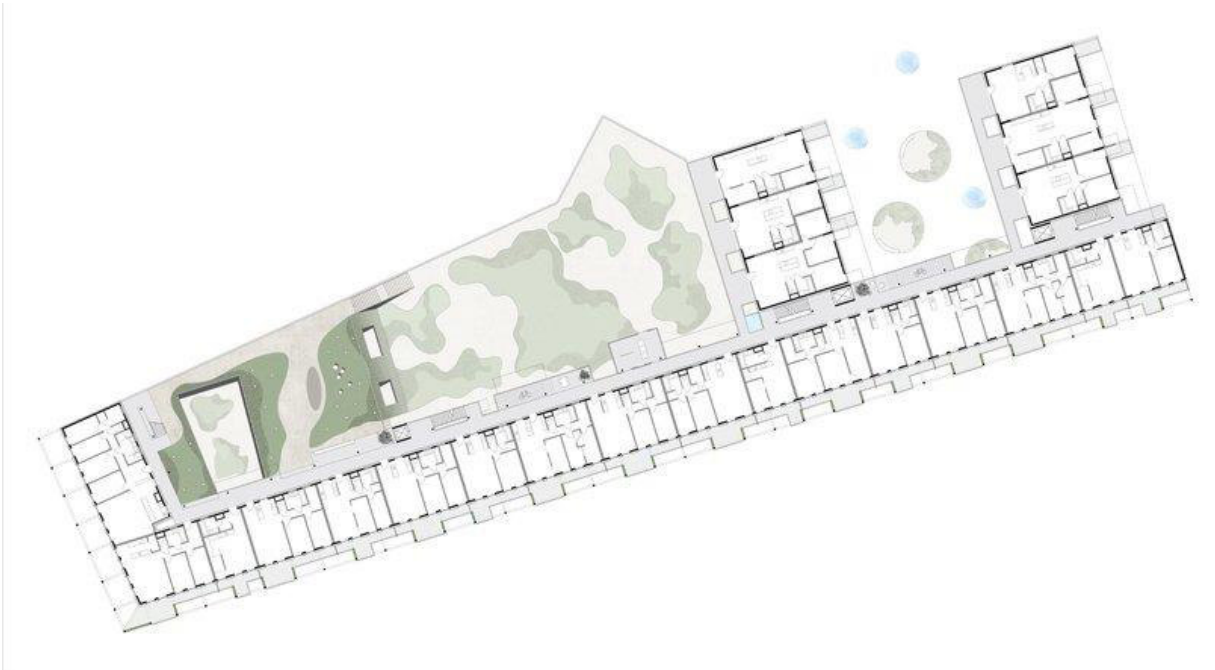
Sonnwendviertel B.04 Grundriss
